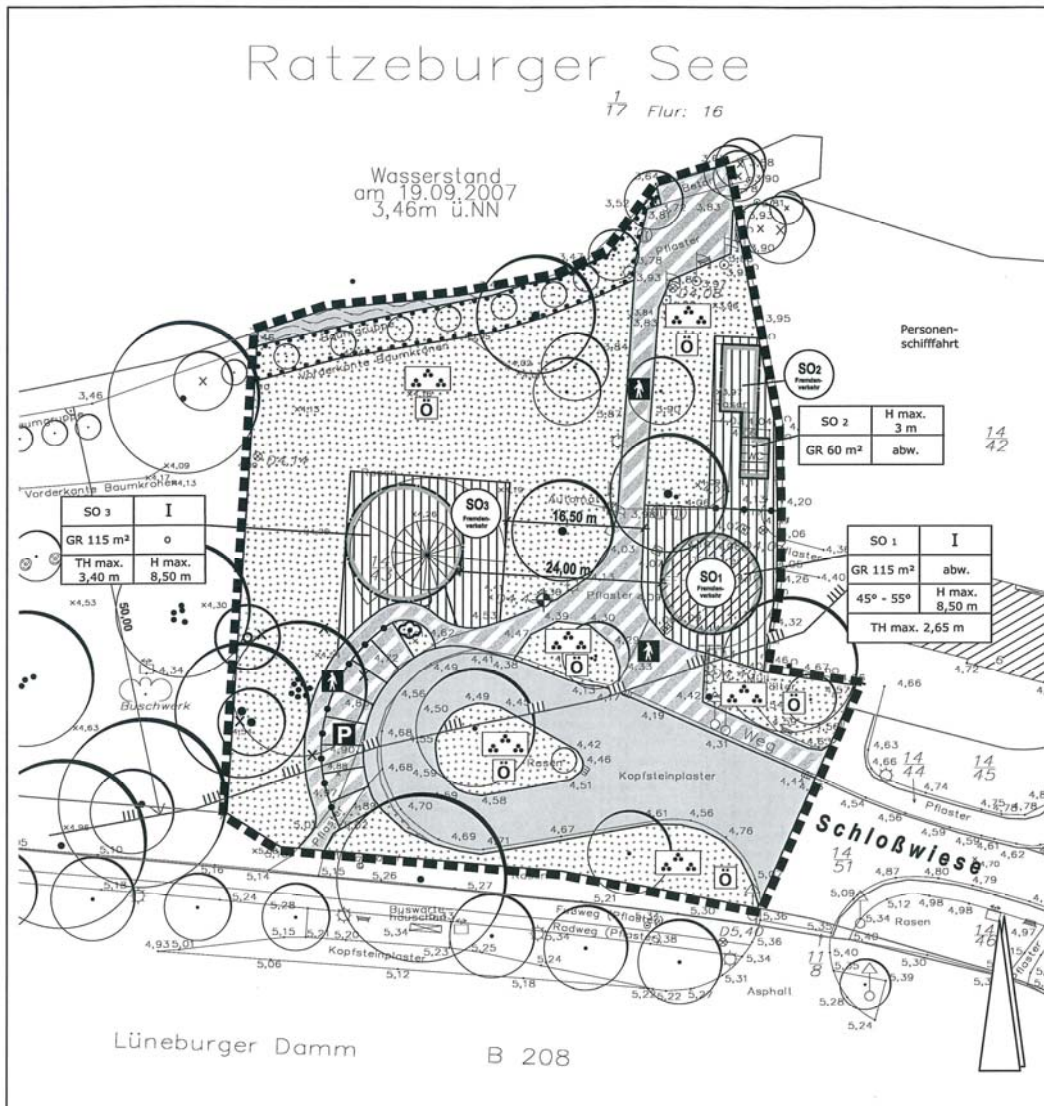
Planzeichnung des rechtskräftigen B-Plans Nr. 77 (ohne Maßstab)
